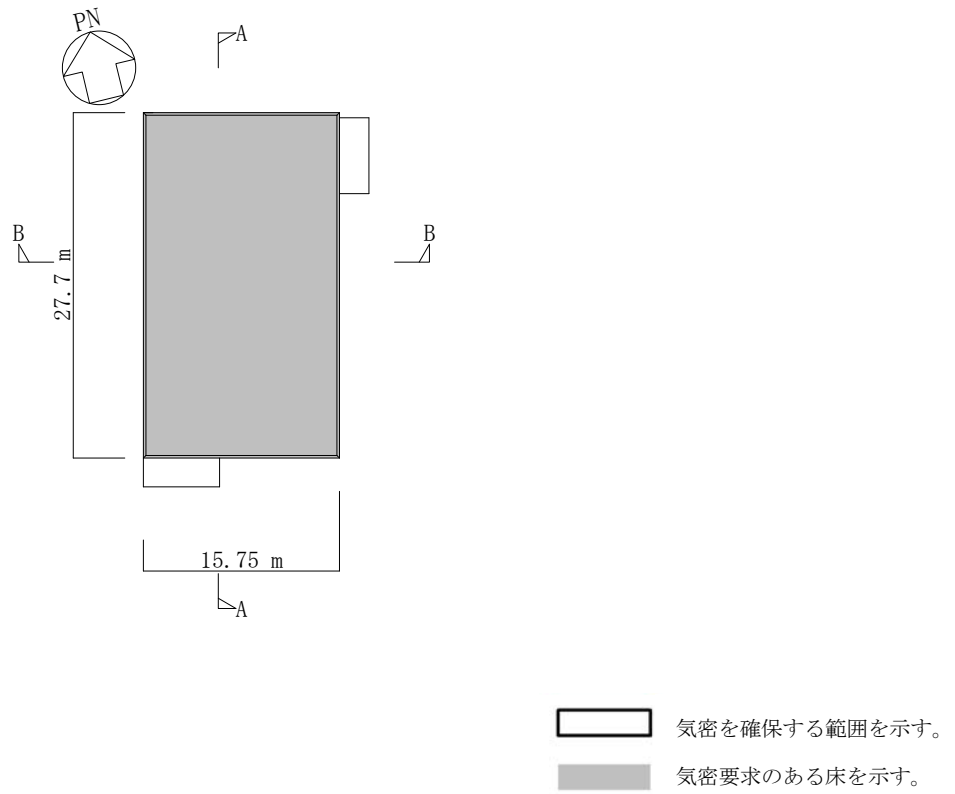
(5/7) 気密性を確保する範囲 (R 階平面図 : EL. 51.0 m)
